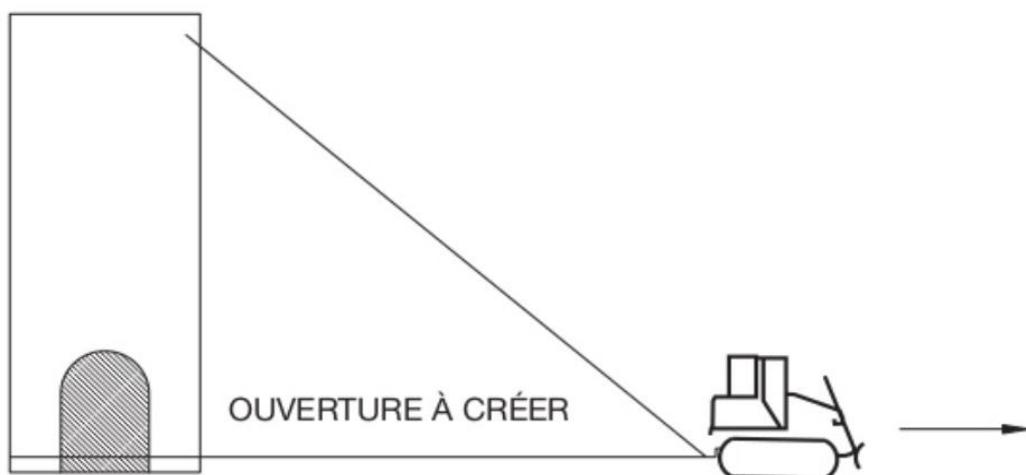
Tirage au câble en tête et pied d'ouvrage.
